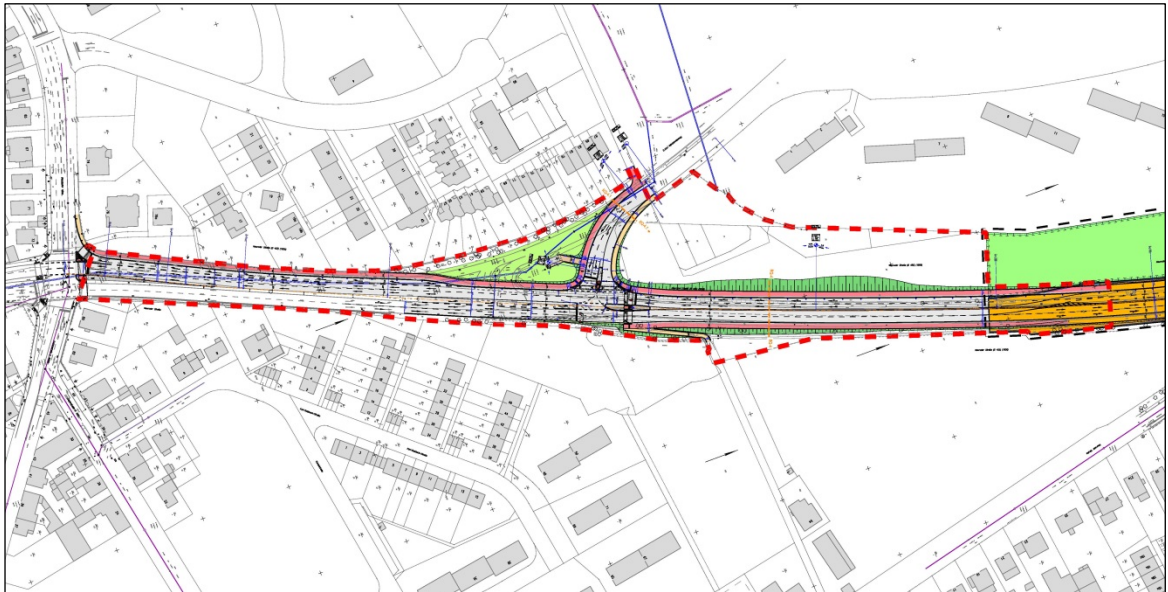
Geltungsbereich Bebauungsplan Bauabschnitt Süd
